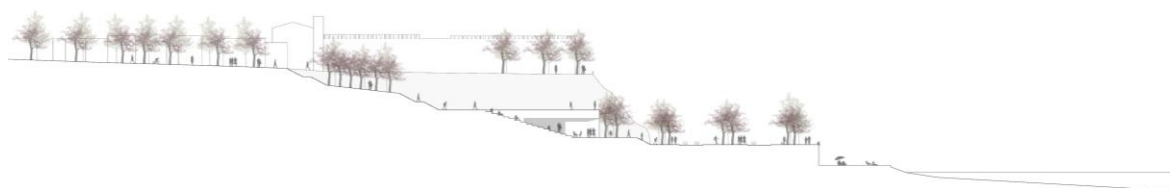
Proposta detalhada Corte AA' (anexo 11)
